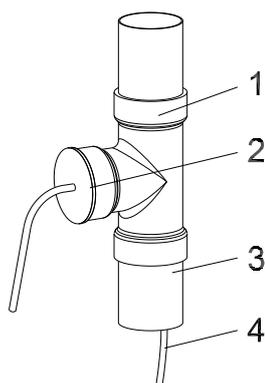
Installazione di un interruttore a galleggiante Sanisett (*Collegamenti cavi)
